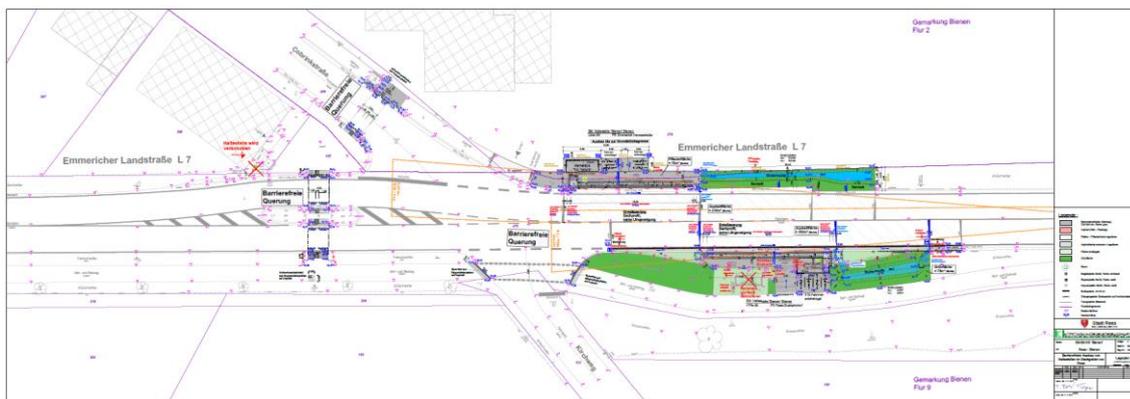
Planungen Emmericher Landstraße (L7) im Bereich der Cobrinkstraße
